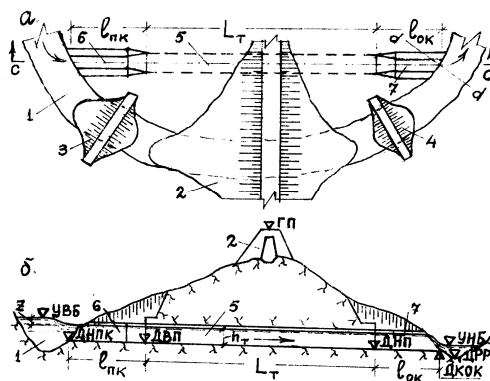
Водохранилищный гидроузел со строительным водосбросом:
